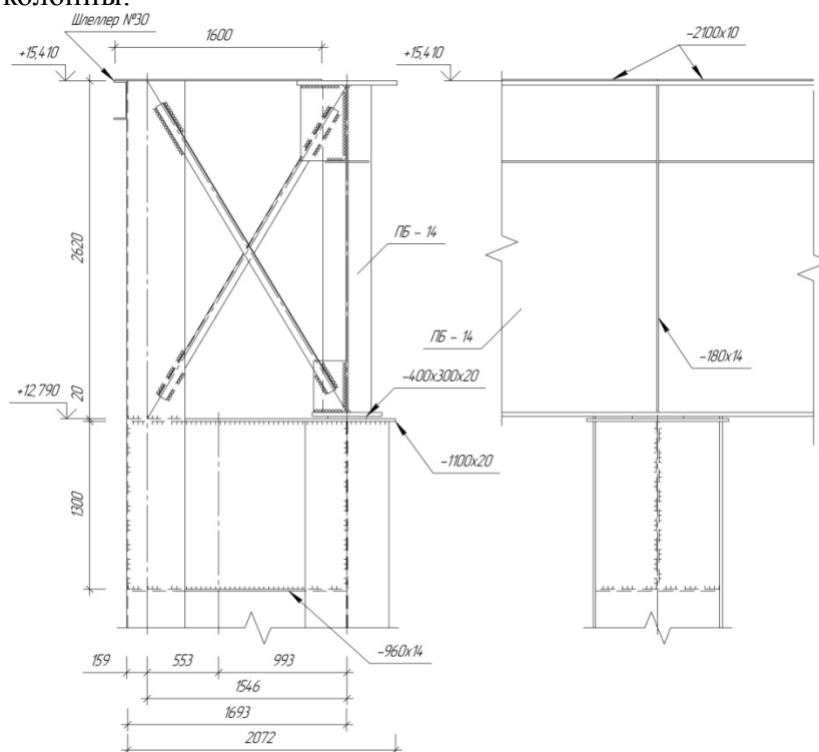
Опорный узел соединения подкрановой балки ПБ-14 с промежуточной колонной К2-2а.
